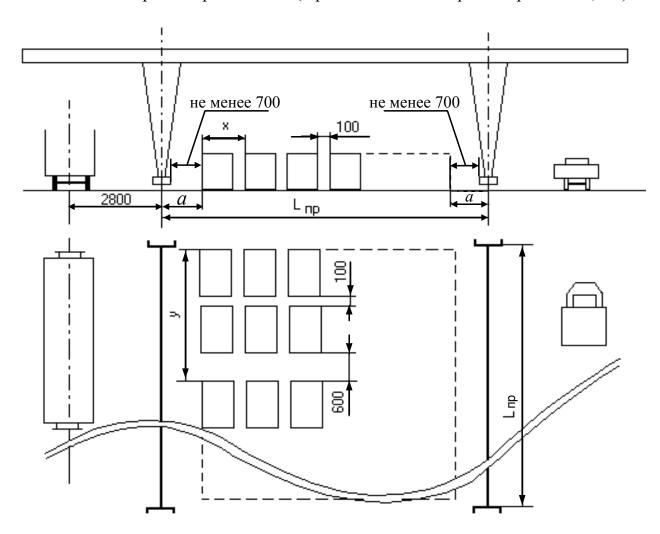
Поперечный разрез и план контейнерной площадки для среднетоннажных контейнеров
